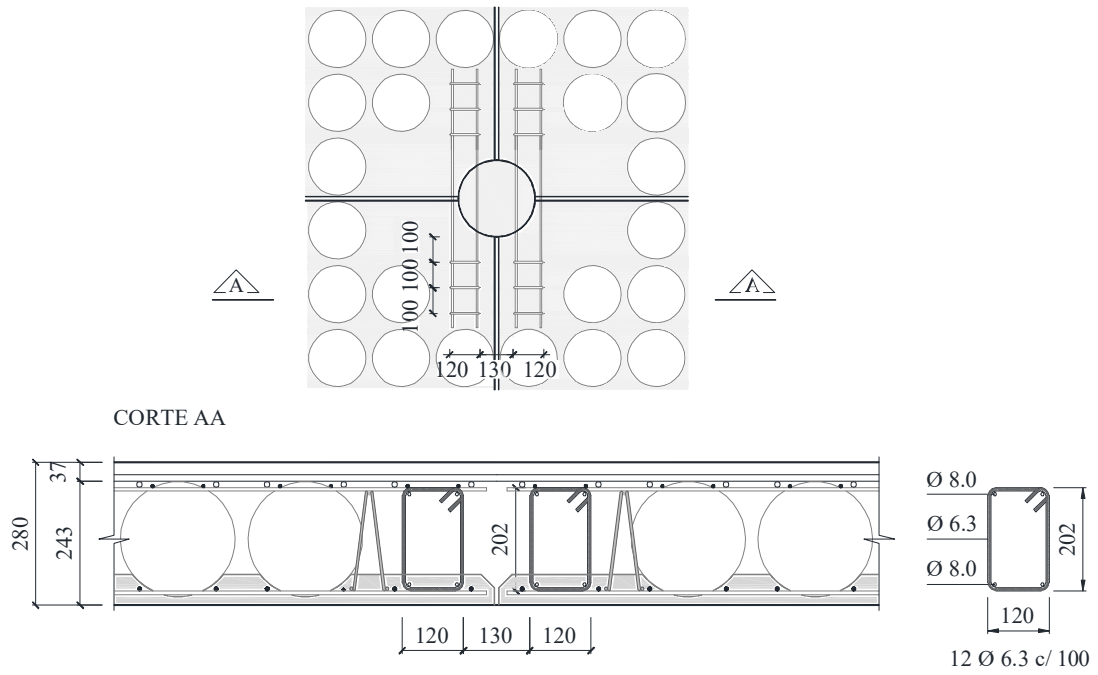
Detalhe dos estribos da laje BD28-P3
